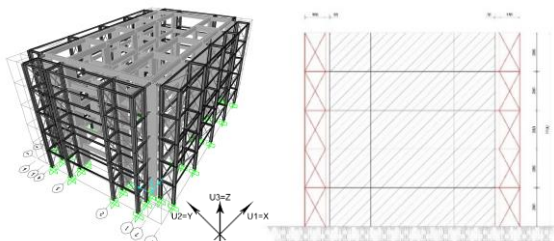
Modello agli elementi finiti dell'edificio con la nuova struttura (sulla sinistra) e schema geometrico in sezione dell'applicazione della struttura (sulla destra).
